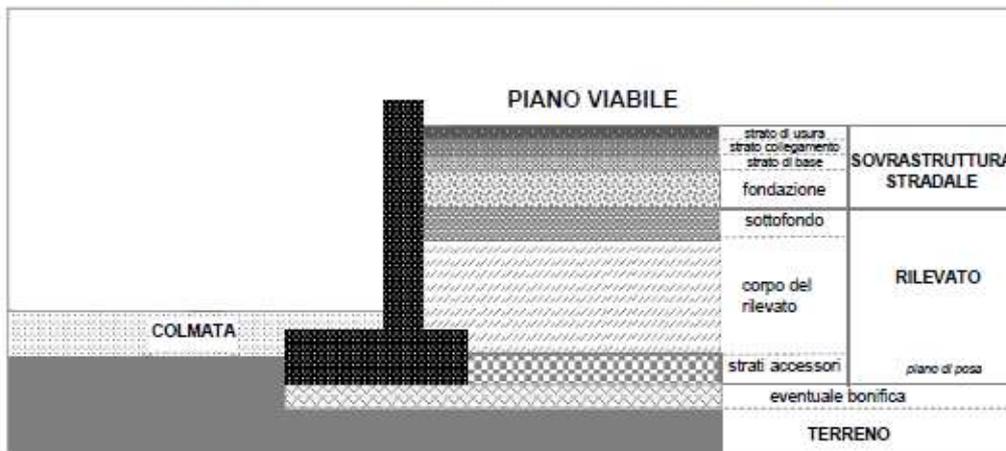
Esempio schematico di sezione del corpo stradale in rilevato con muro di sostegno
